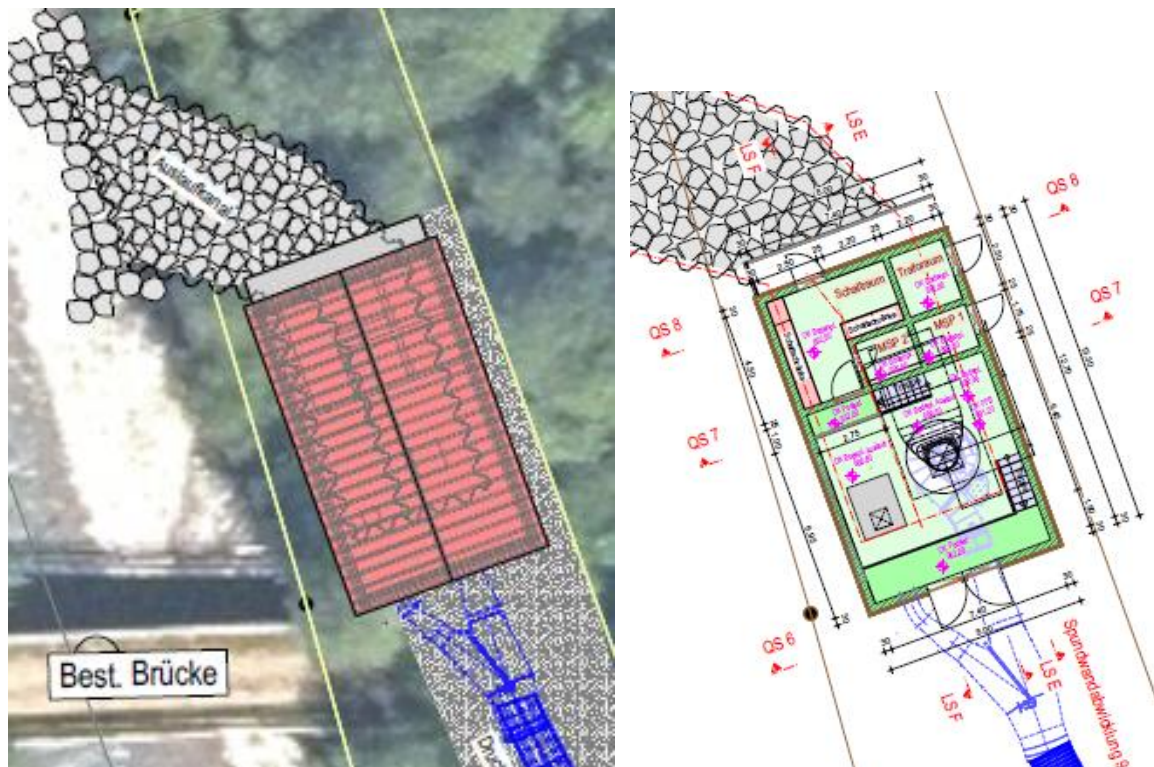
Lageplan Krafthaus mit Unterwasserkanal
